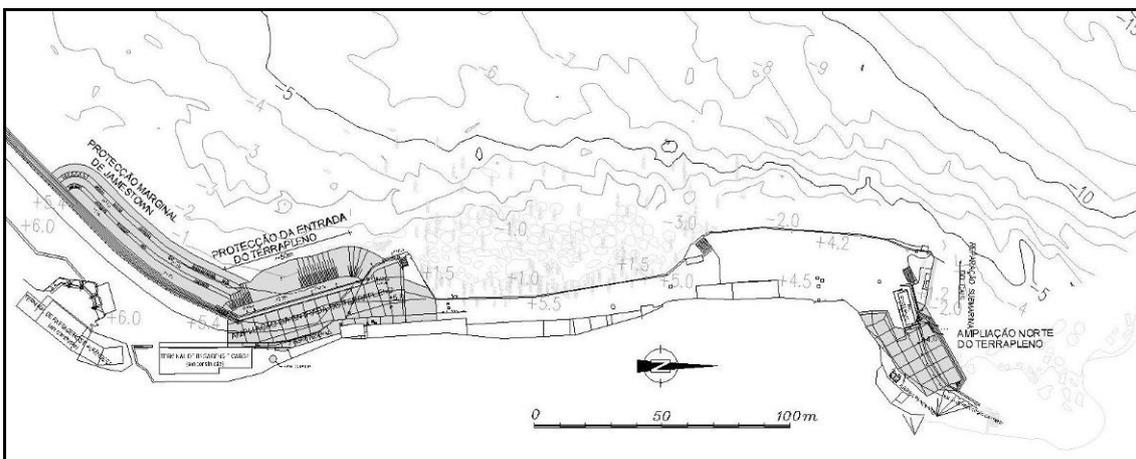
Planta de arranjo geral da Fase 1 (alteração)
